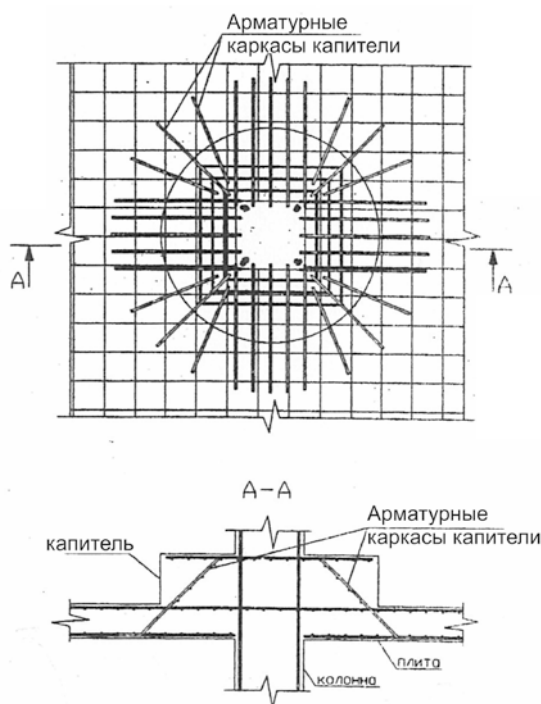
Узел сопряжения плиты с колонной с капителью расположенной на перекрытии [10]
